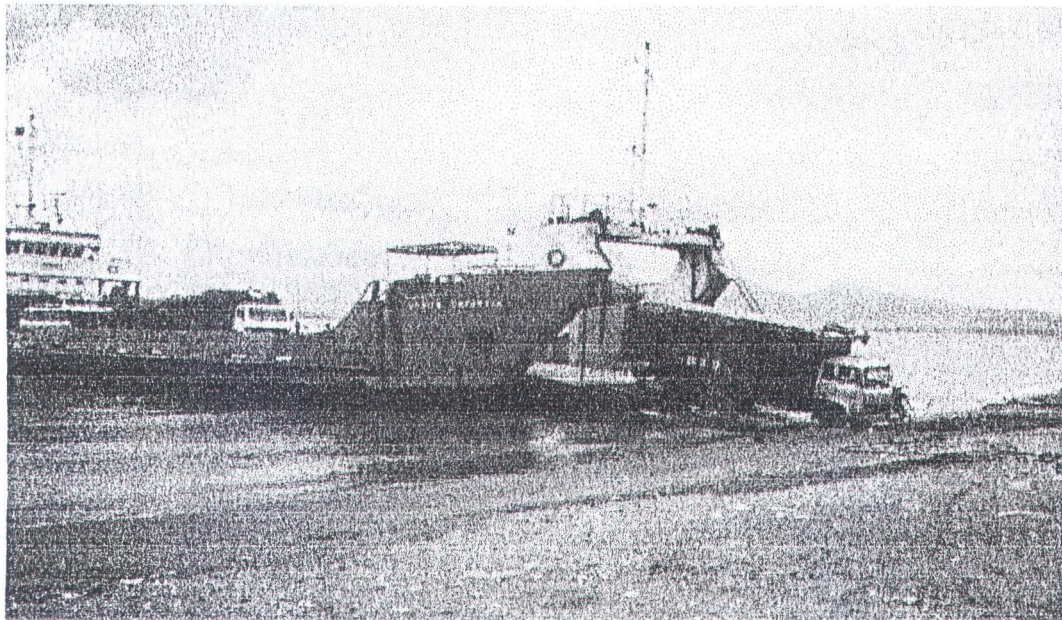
Bentuk Dermaga MB (*Moveable Bridge*)
